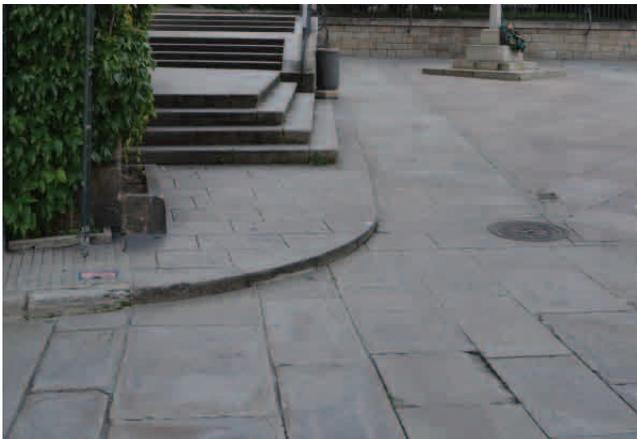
Huecos y resaltes en el pavimento y escaleras (fuente propia, plz. Constitución)
